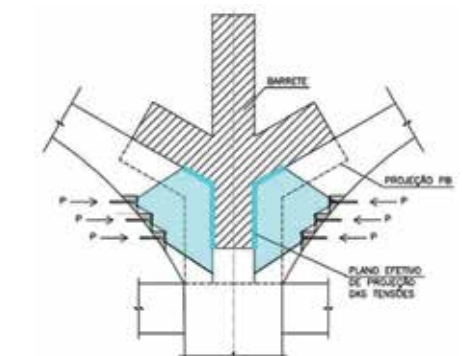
A - Esquema de Ligação da estronca com Barrete utilizando barras de protensão
